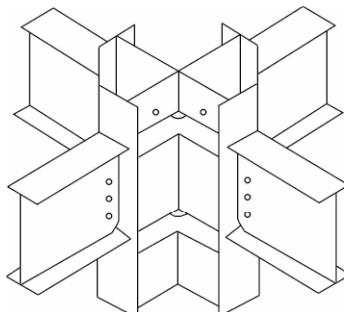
型钢混凝土梁柱节点及水平加劲肋
